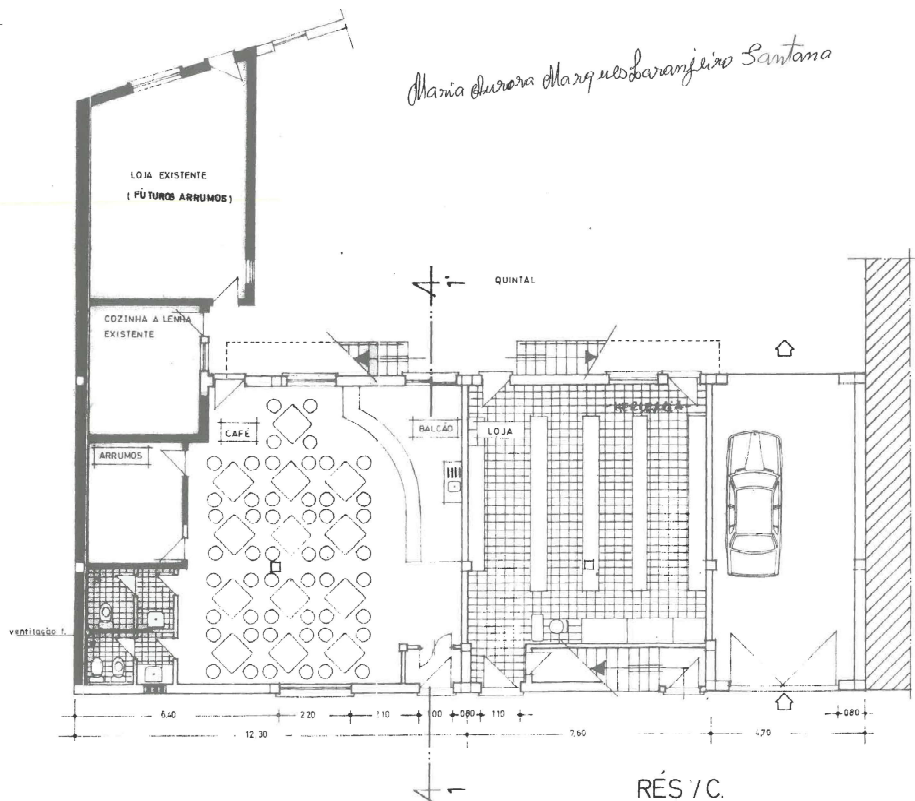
Planta original do estabelecimento, Fonte: Dona do estabelecimento, 2024
